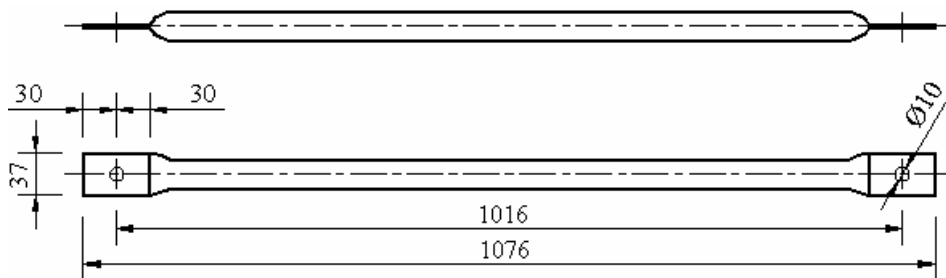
Diagonal - detalhe do amassamento e furação (mm)
